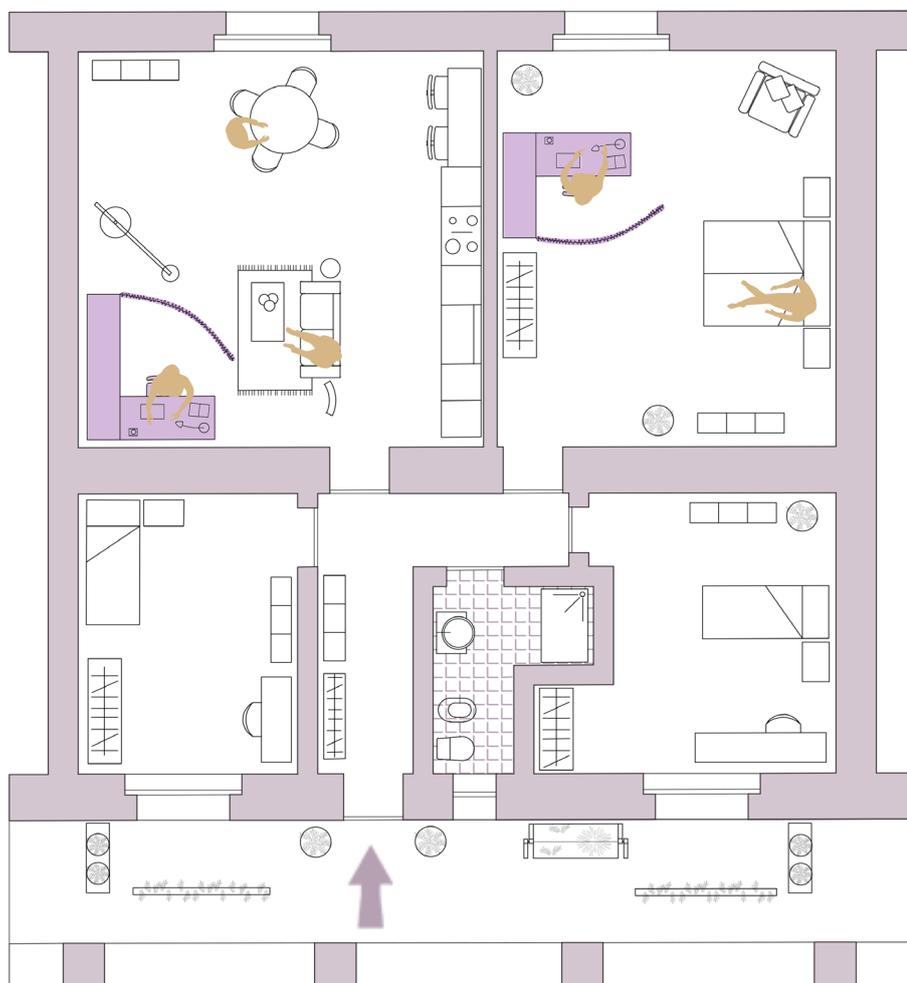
Rappresentazione planimetrica soluzione ambiente studio / lavoro in due spazi diversi della casa.
